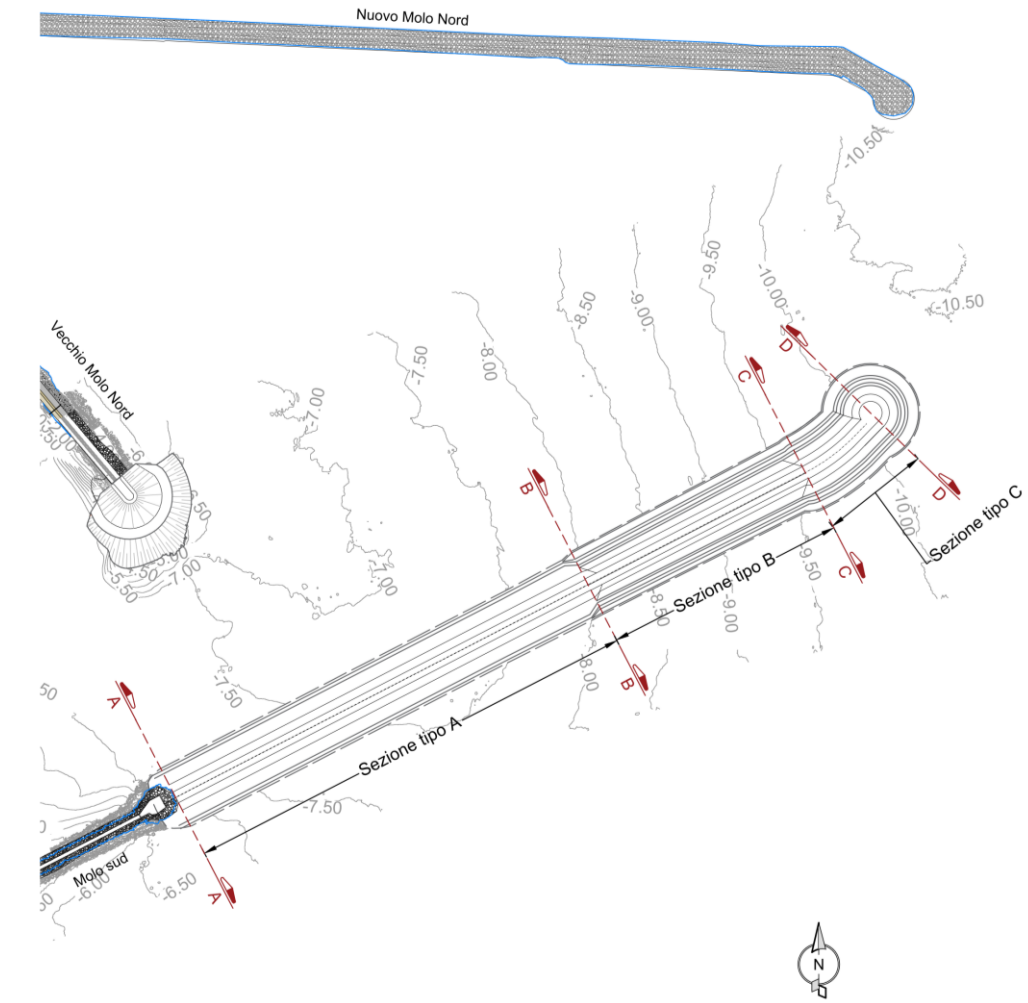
Planimetria delle sezioni per il prolungamento della Diga Foranea Sud
